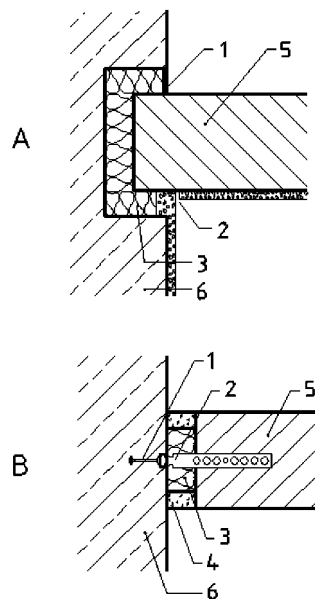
Plantas de los encuentros entre un muro (pilar) y un muro
